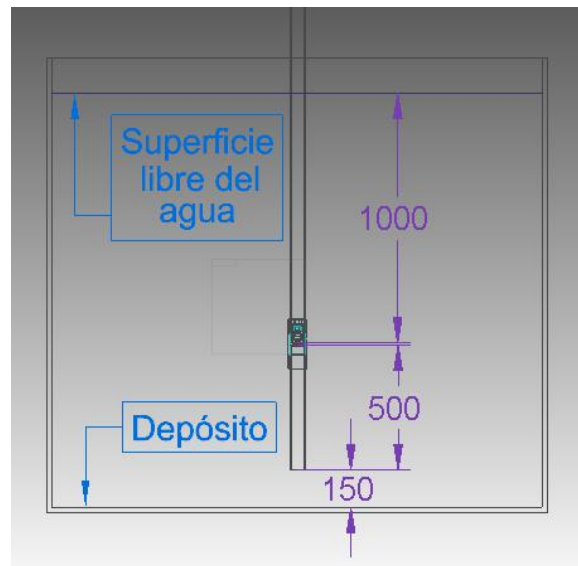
Detalle instalación con longitud de la tubería de succión y distancia hasta el fondo del pozo reducidas (mm).
